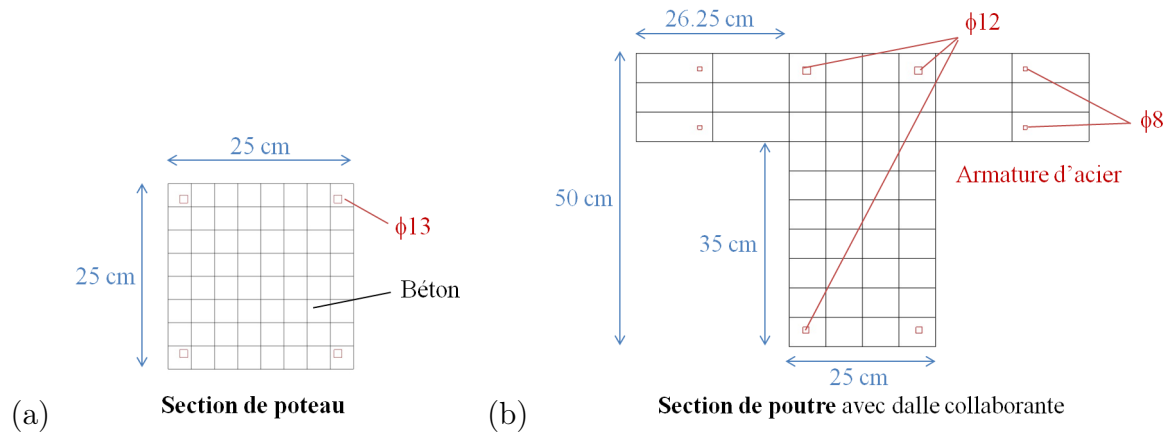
Sections utilisées pour la structure poteaux-poutres : (a) pour les poteaux et (b) pour les poutres (Tataie, 2011)
